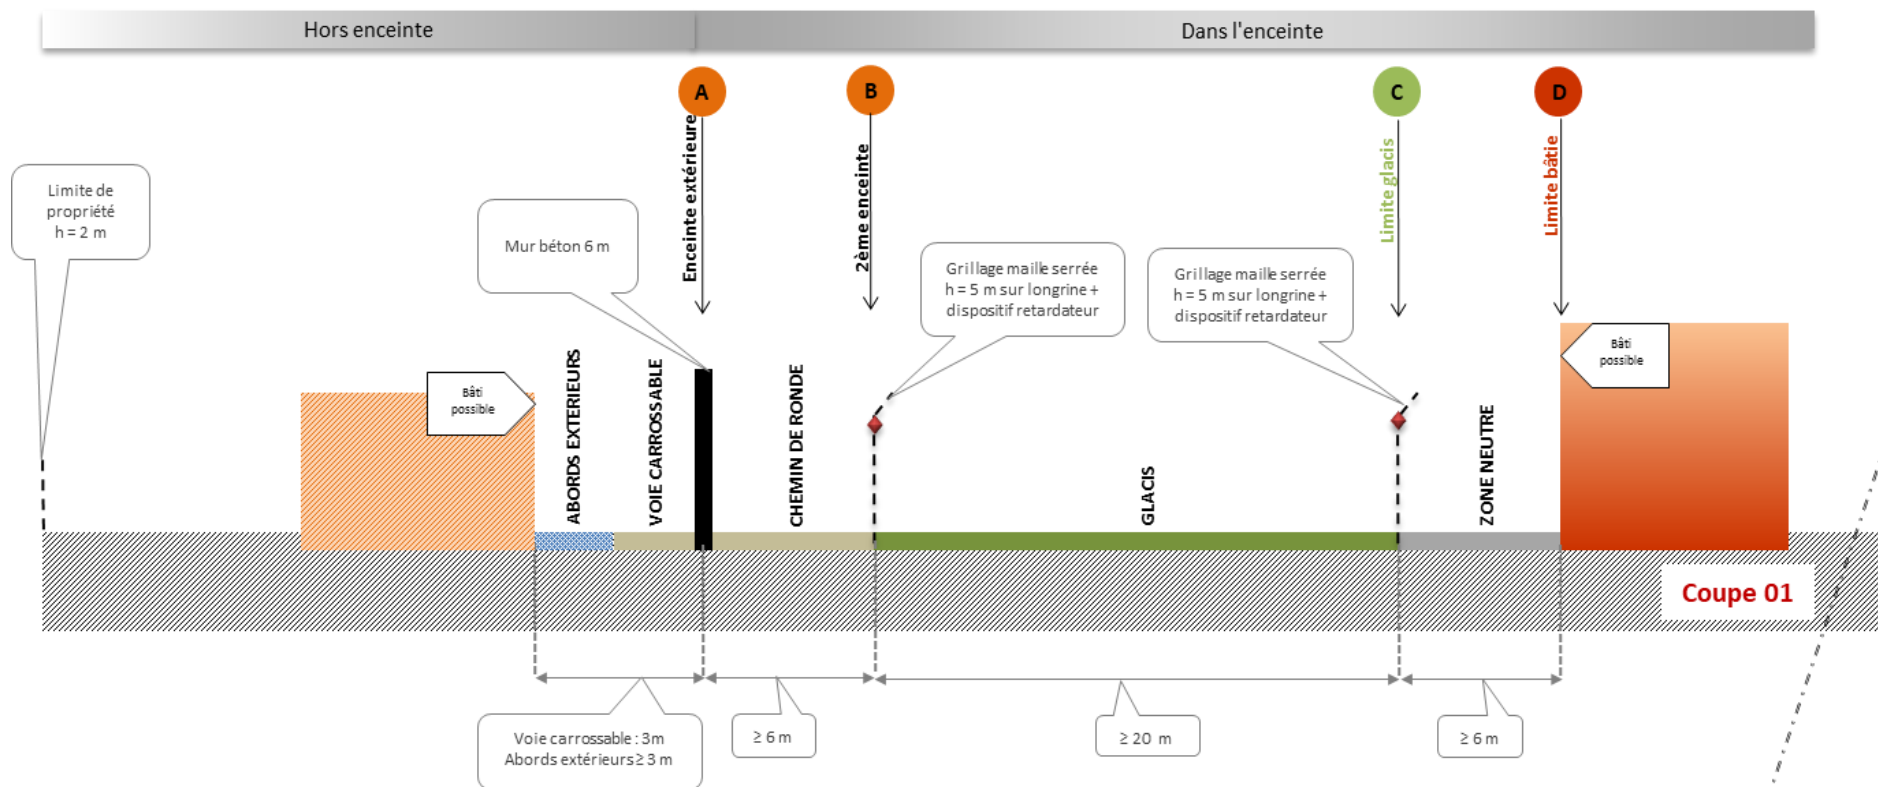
Coupe type - Enceinte délimitée par un mur béton de 6 m de haut (Source : APIJ)
